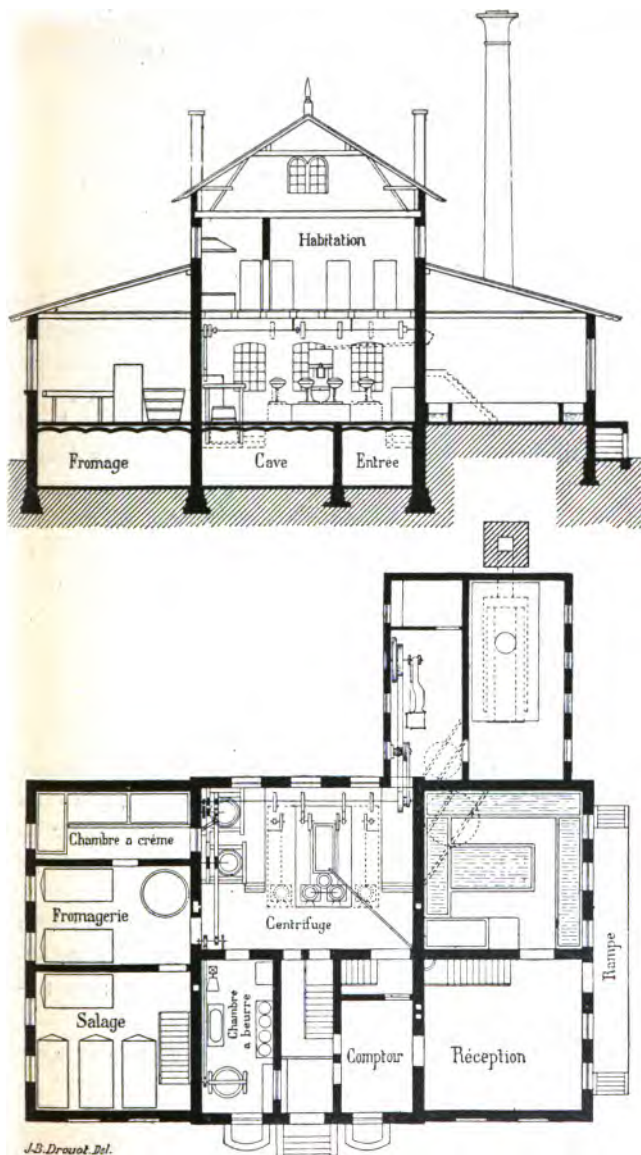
PLAN D'UNE GRANDE LAITERIE ALLEMANDE.
